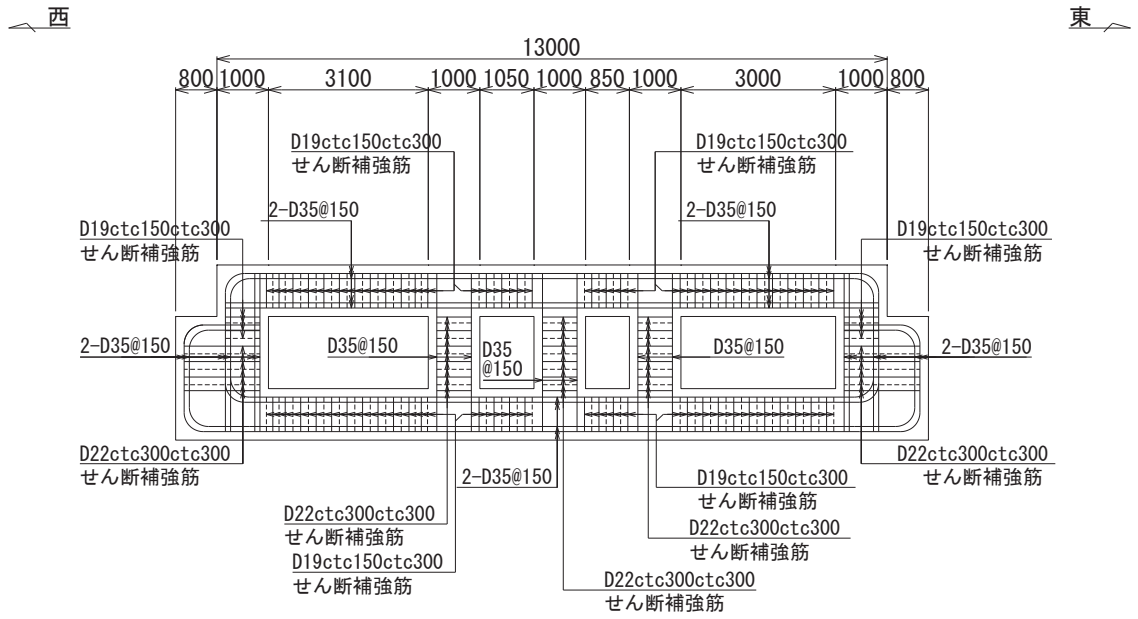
第 3 号機補機冷却海水系放水ピット概略配筋図 (平面図)
